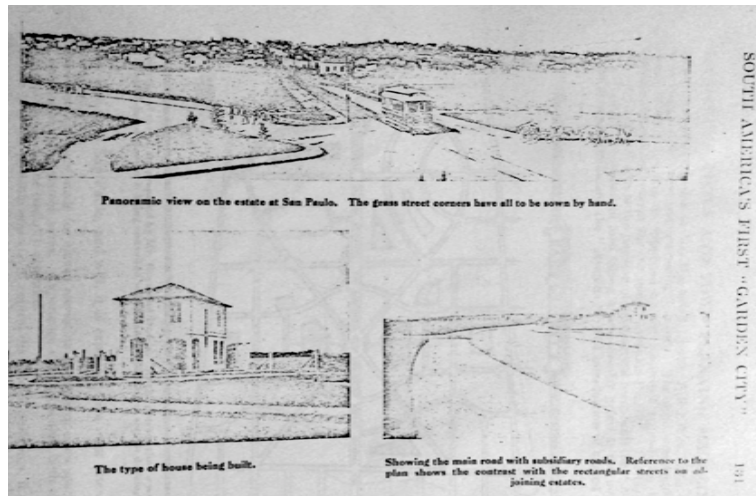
Panoramic view on the estate at San Paulo. The grass street corners have all to be sown by hand. [acima] The type of house being built. [abaixo, esq.] Showing the main road with subsidiary roads. Reference to the plan shows the contrast with rectangular streets on adjoining estates. [abaixo, dir.]. Cópia xerográfica. Foto da autora, 2015.
